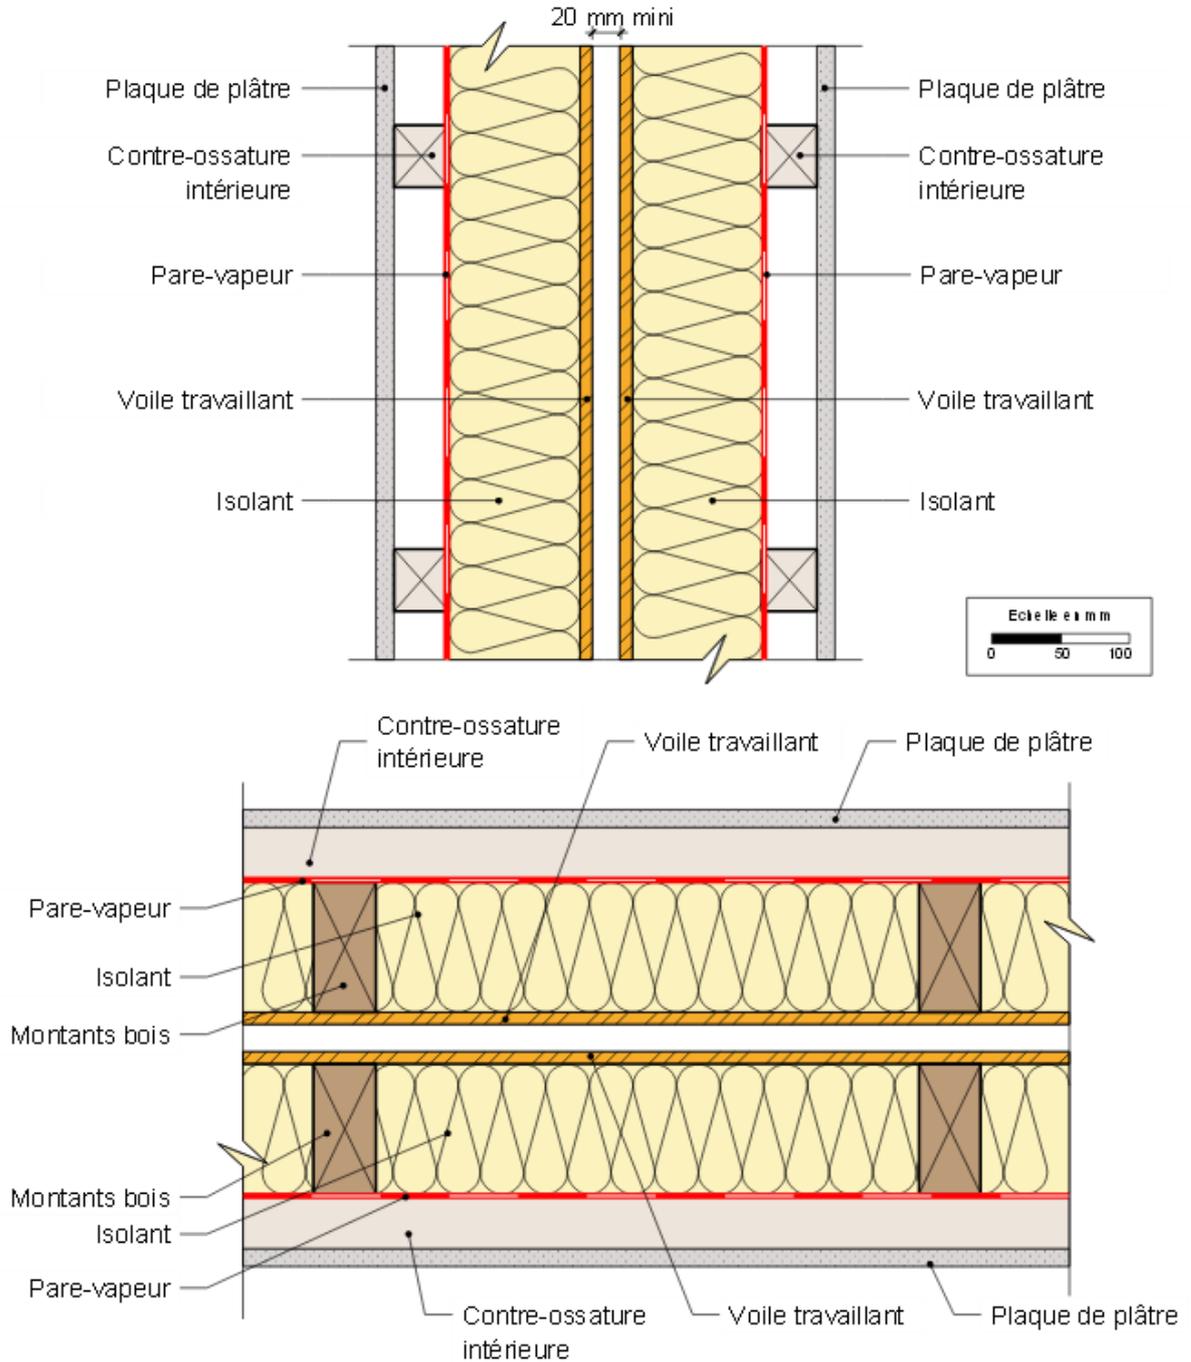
Contreventement côté lame d'air (coupe verticale en haut, verticale en bas)
